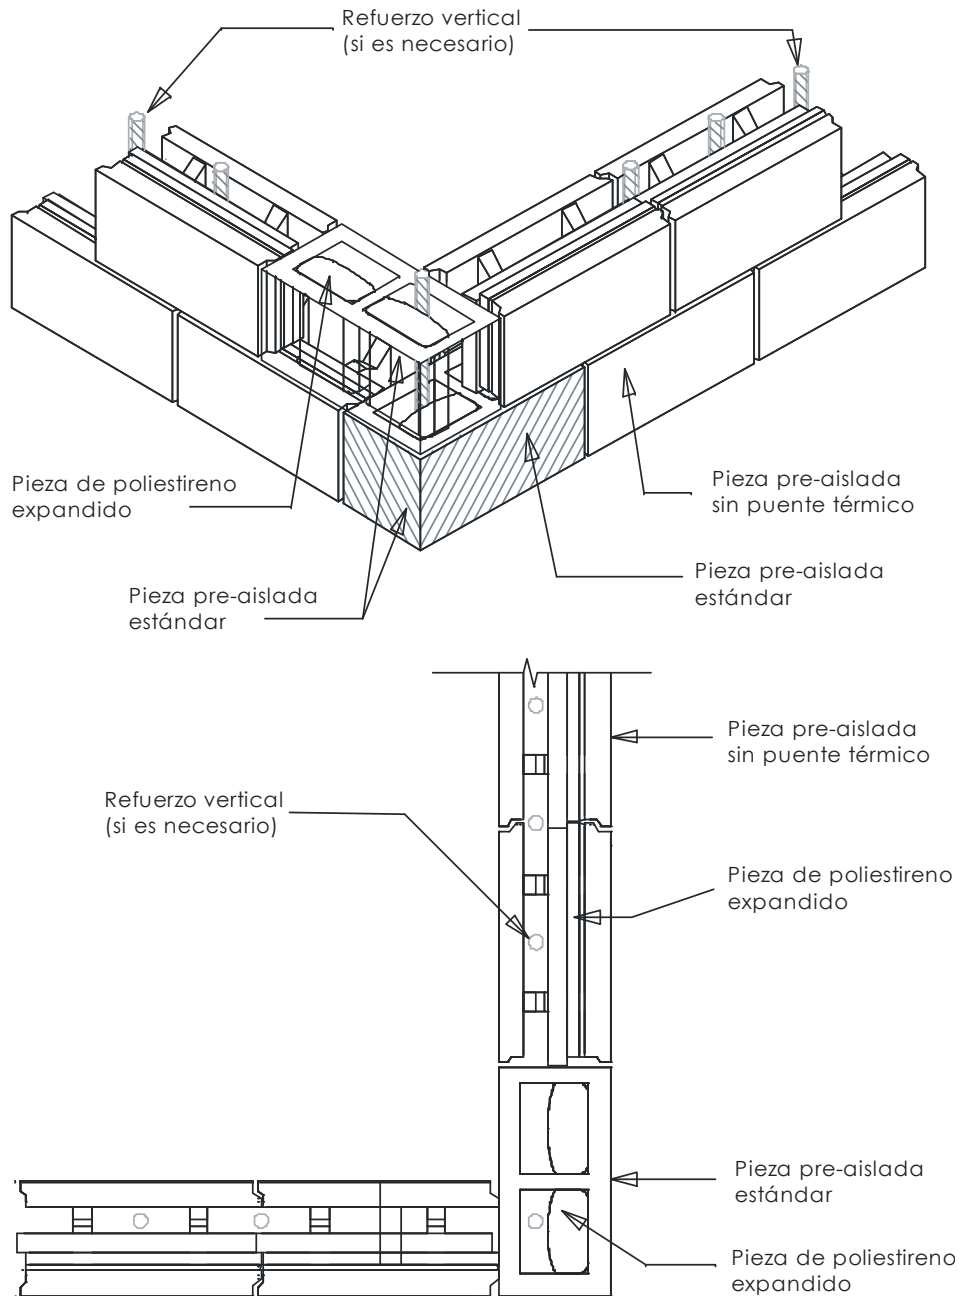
Detalle en esquina con piezas pre-aisladas.
